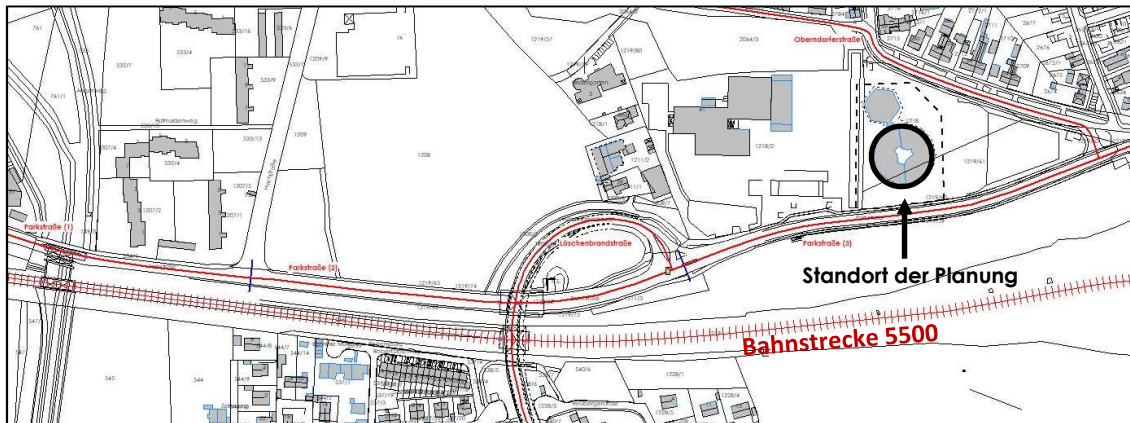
Lageplan mit Darstellung der Bahnstrecke 5500 und des Standorts der Planung
